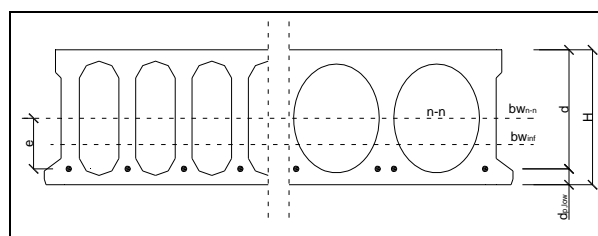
Particolare della geometria delle nervature tipica dei solai vibrofiniti ed estrusi.
